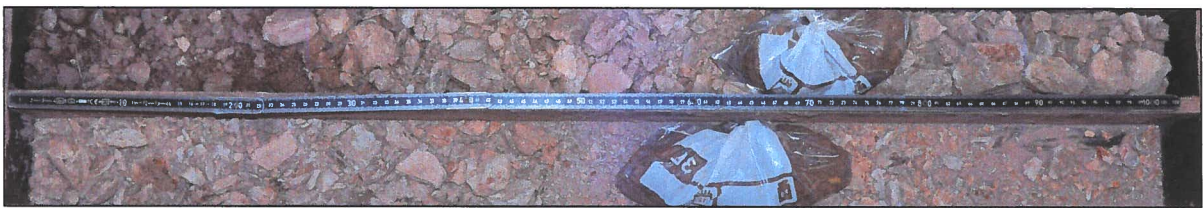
Erkundungsstelle 2 – Bohrgut Kleinrammbohrung
